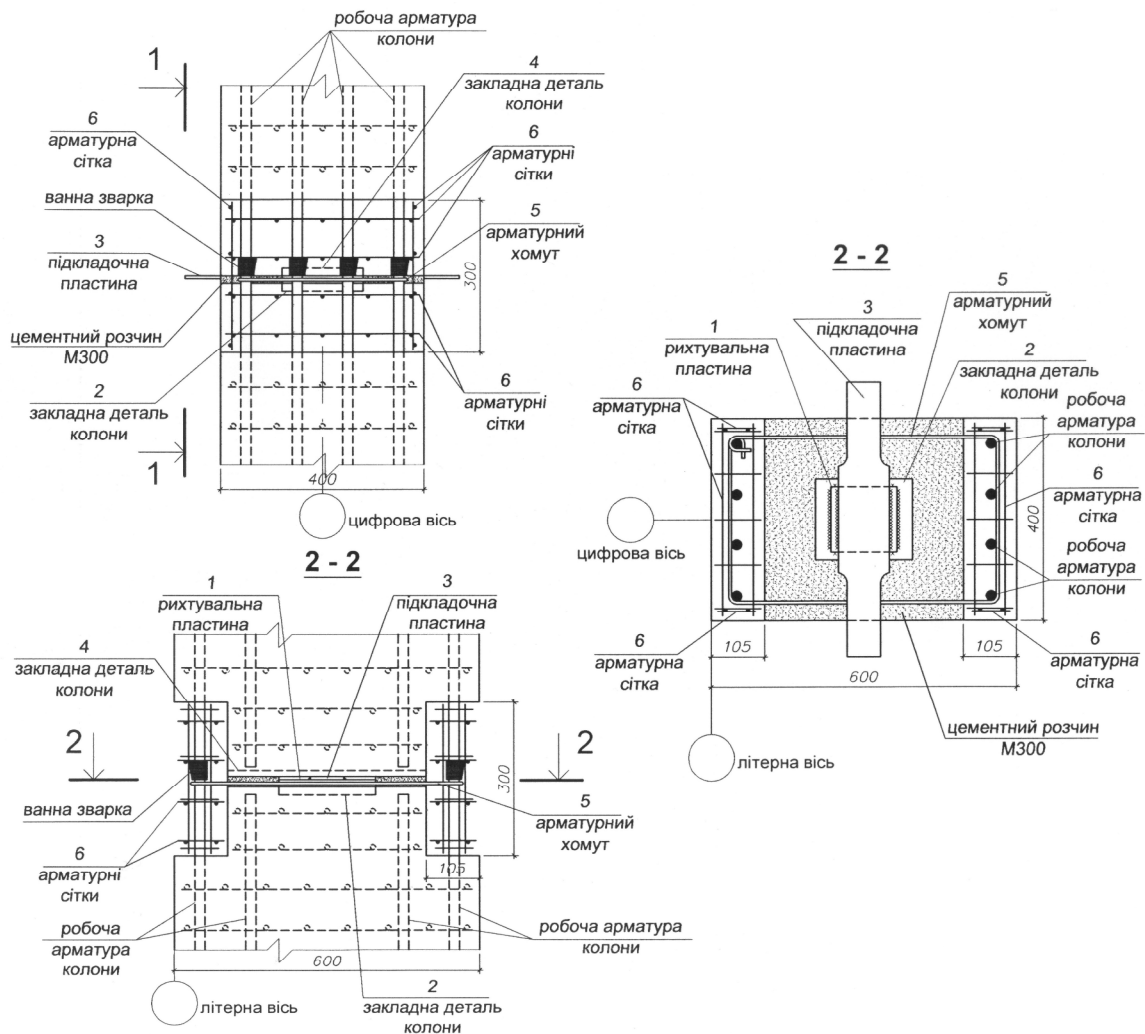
Проектний стик залізобетонних колон за серією 1.420-12
